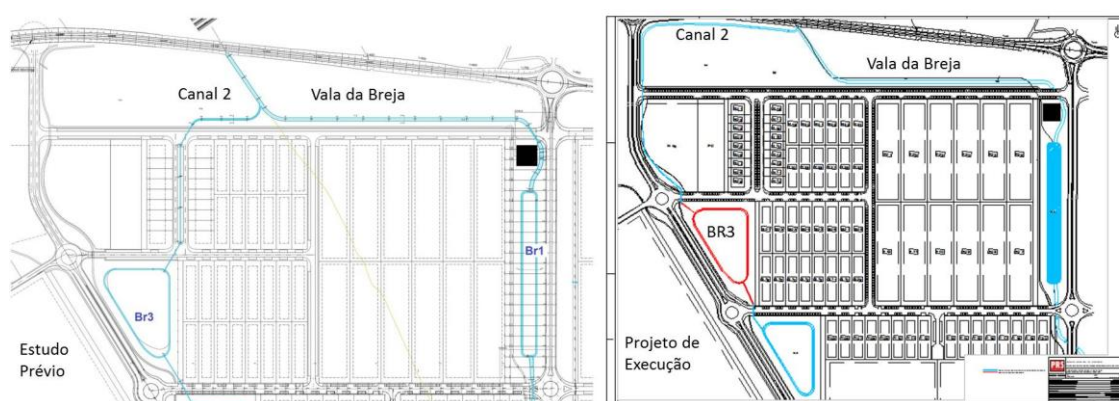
Encaminhamento das águas pluviais em fase de Estudo Prévio e em fase de Projeto de Execução.
